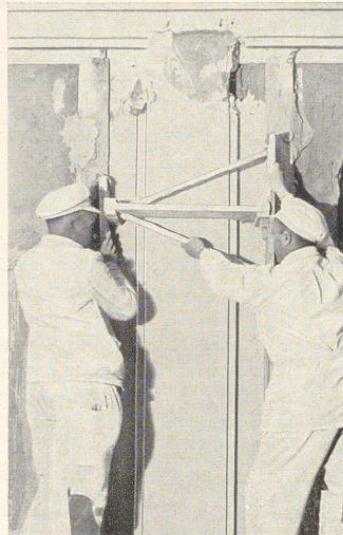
Wandzug eines Pilasters mit Mittelschablone
